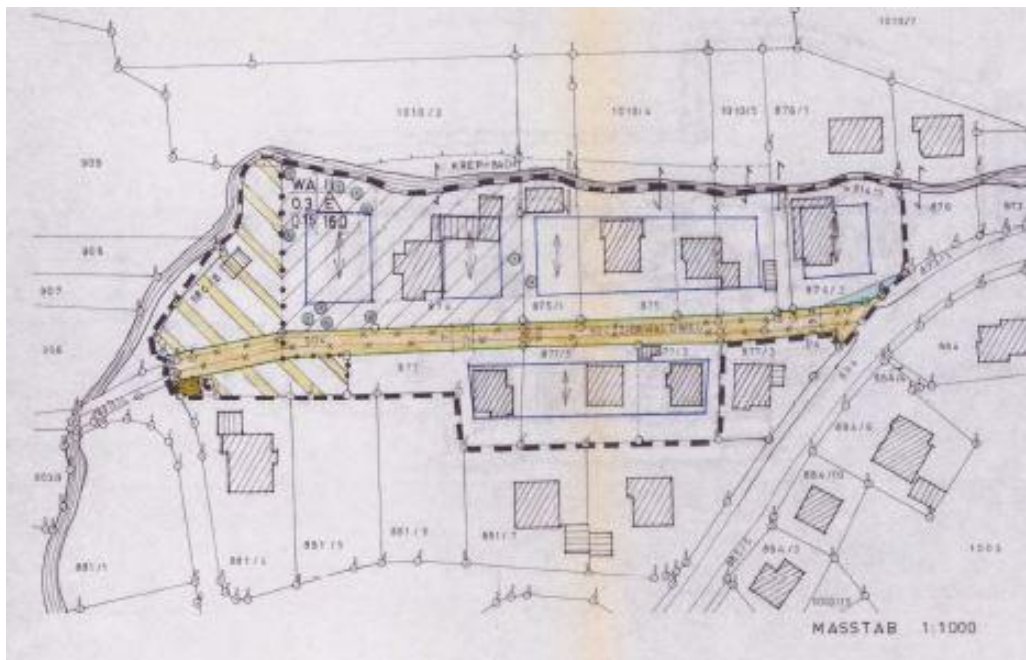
Ausschnitt aus der Planzeichnung des Bebauungsplanes Nr. 19 "Zierwaldweg", unmaßstäblich
